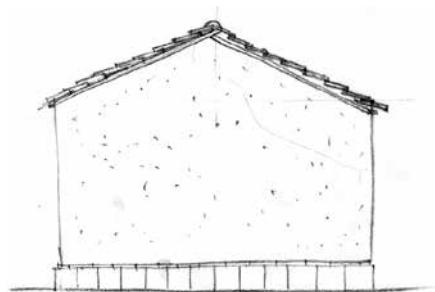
Sistema construtivo em adobe_ Alçado tipo (Carvalho 2006)
